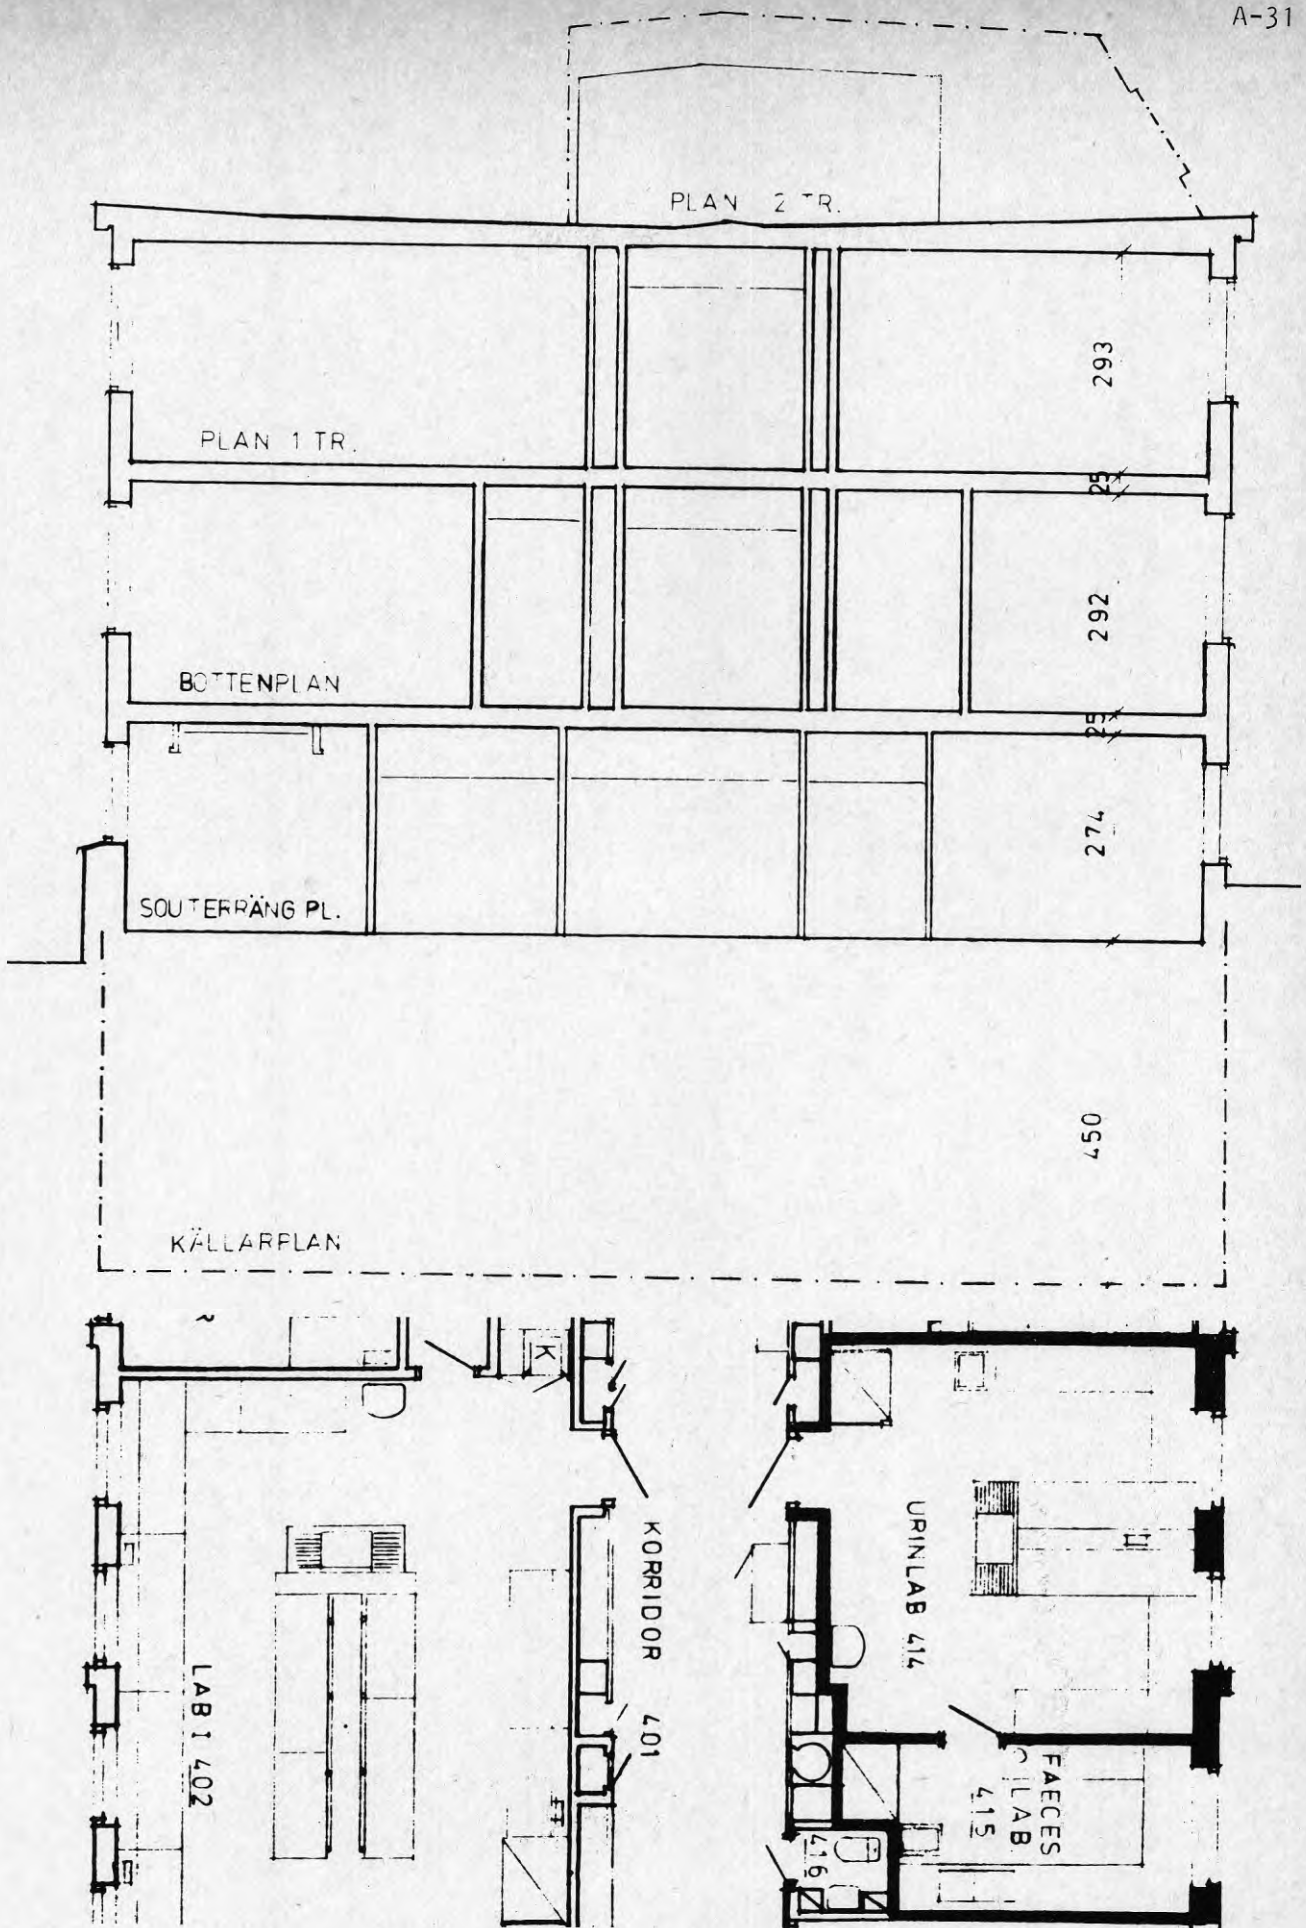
St Eriks sjukhus. Laboratoriebyggnad, snitt och plan skala 1:100.
